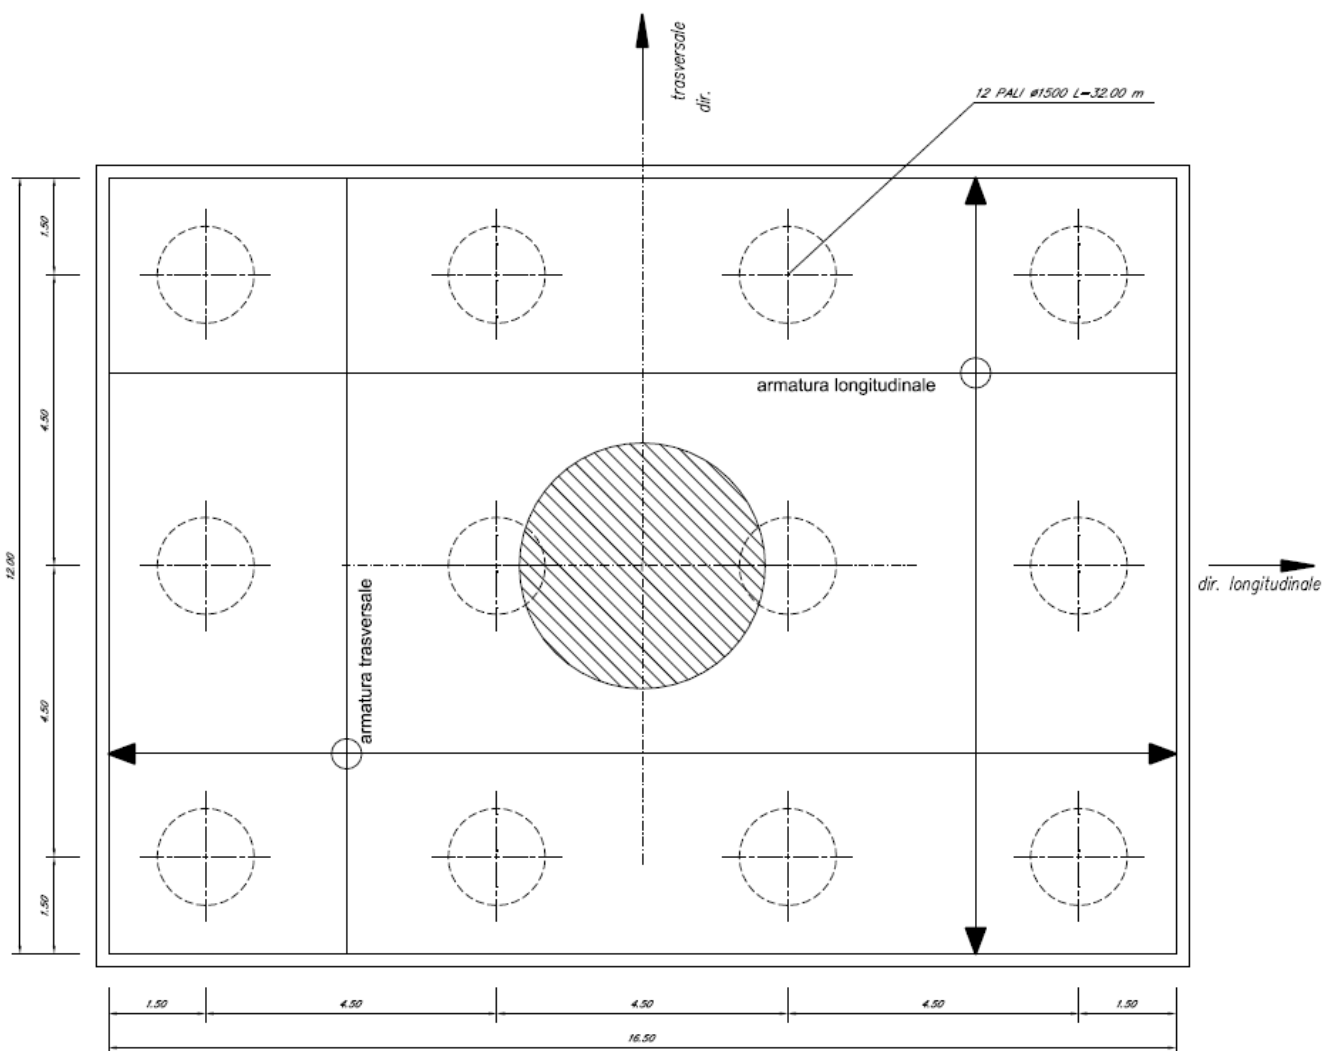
Plinto di fondazione – Armatura longitudinale e trasversale inferiore e superiore
